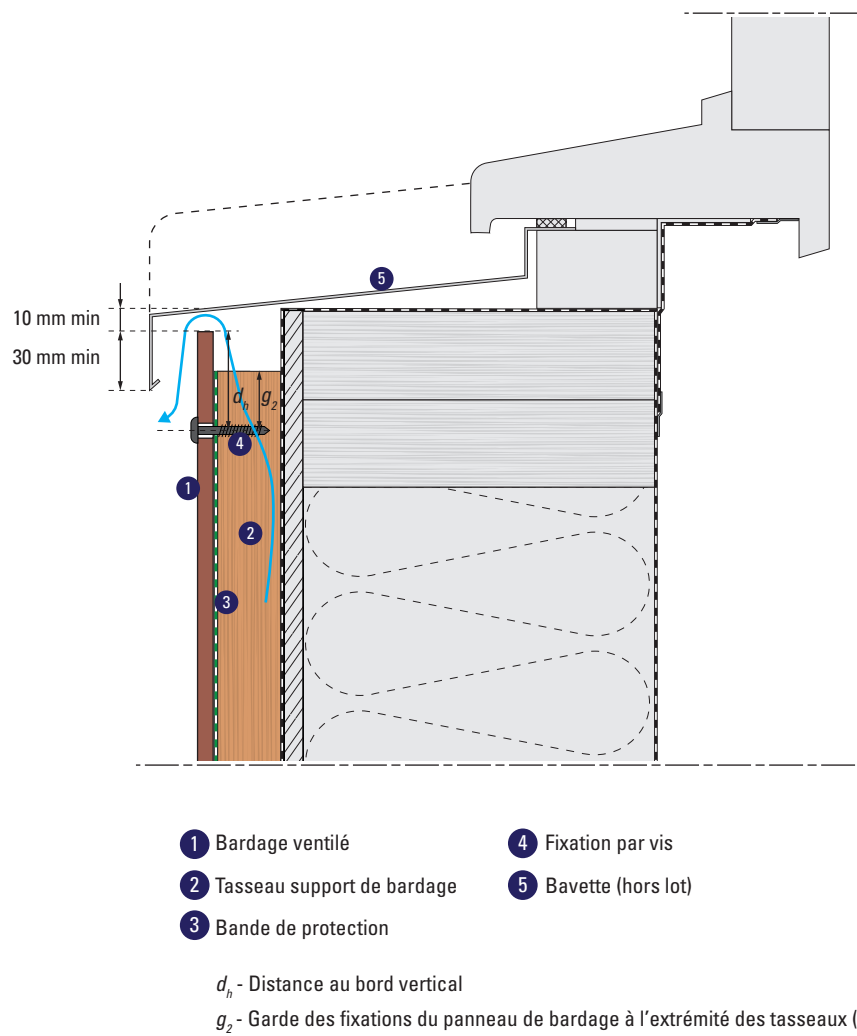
Exemple de mise en œuvre en appui de baie – coupe verticale
